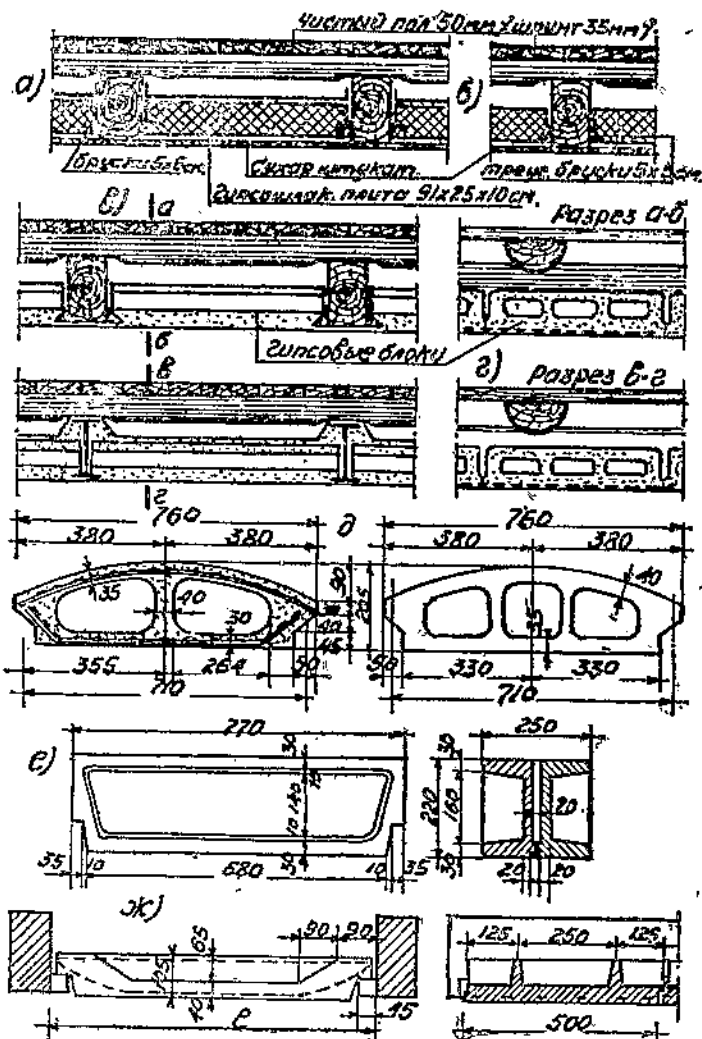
Гипсовые наслы чердачных и междуэтажных перекрытий.
